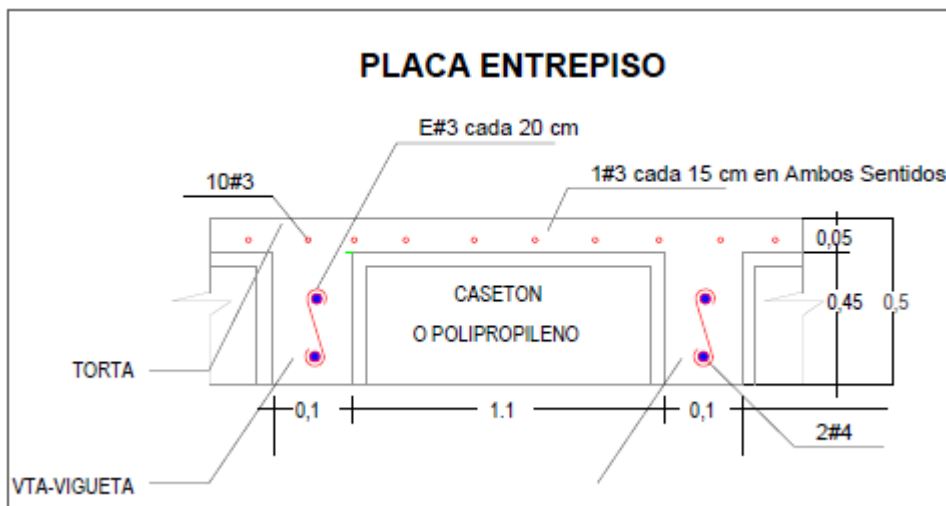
Sección de acero de refuerzo para la losa de entrepiso.
